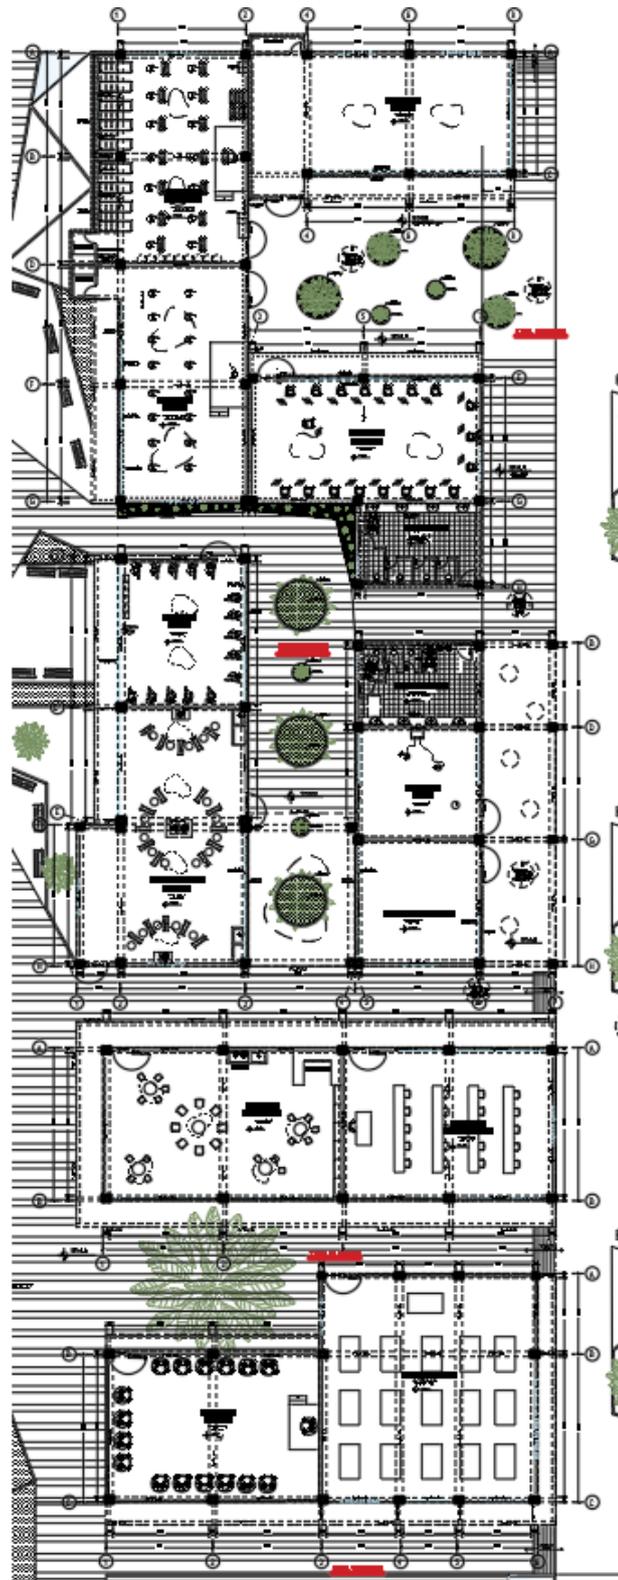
Distribución arquitectónica en planta del 1° piso, “Cafetería”
